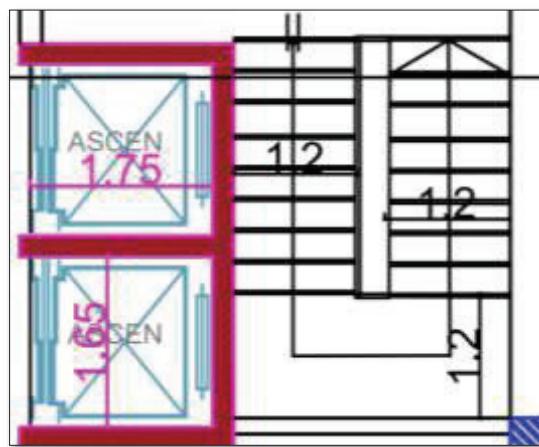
Vue en plan d'escalier sous-sol – RDC.
